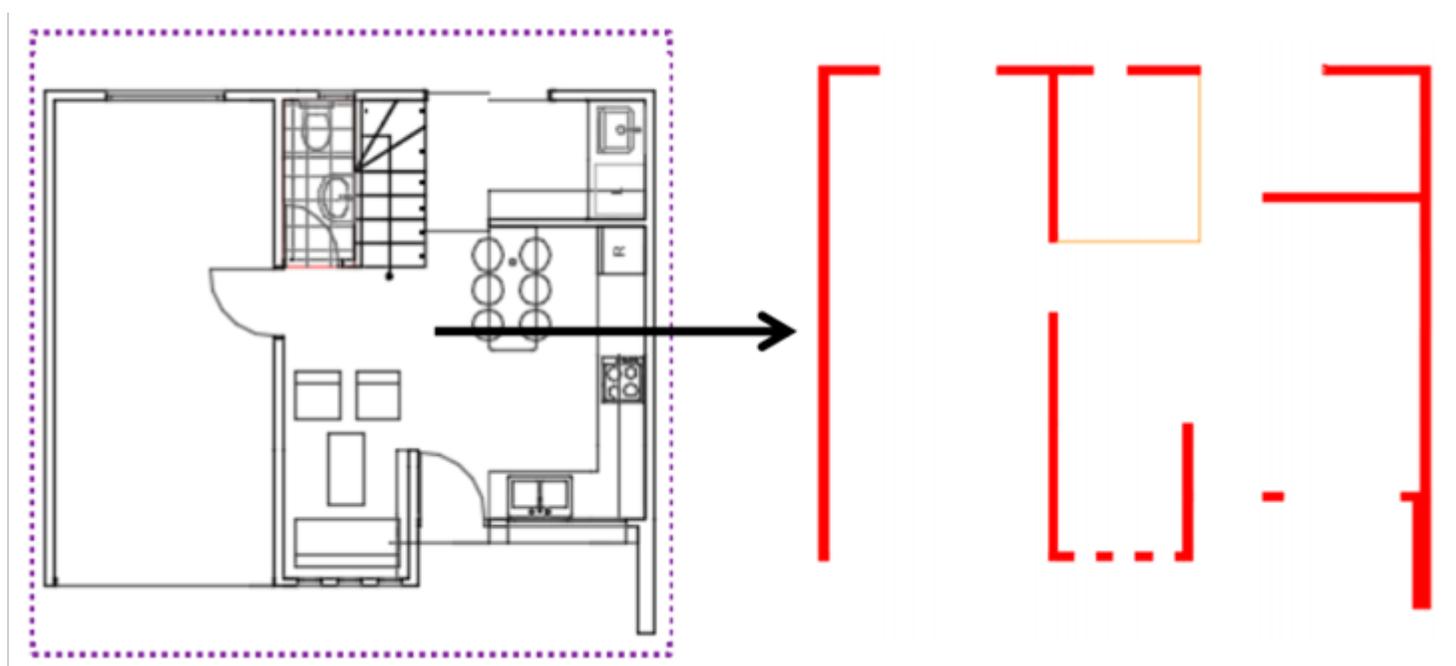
Muros a considerarse para el molde. (planta baja)
